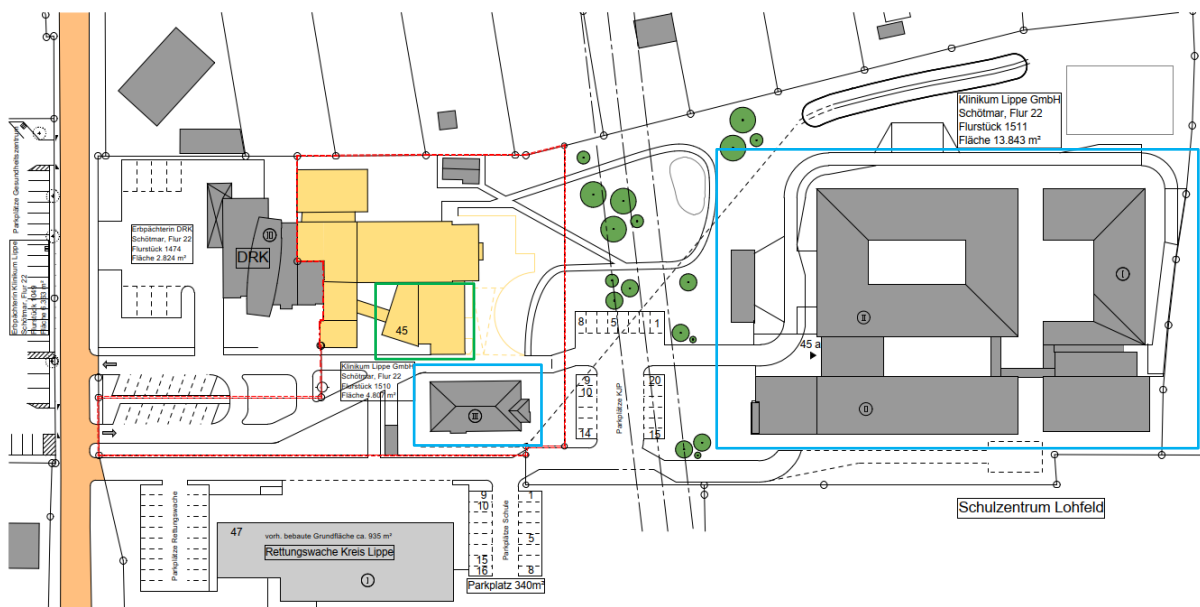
Lageplan KJP Bad Salzuflen, Abbruch gelb, blaue Markierung bleibt bestehen
